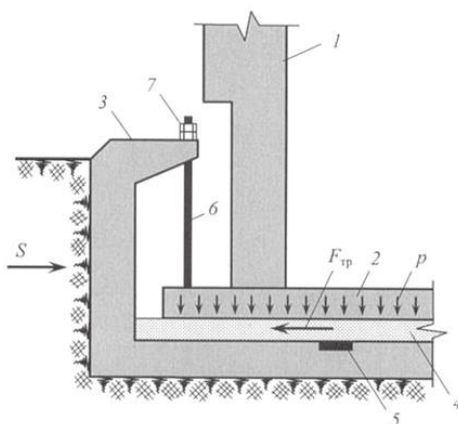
Фундаментная плита с прослойкой демпфирующего материала
